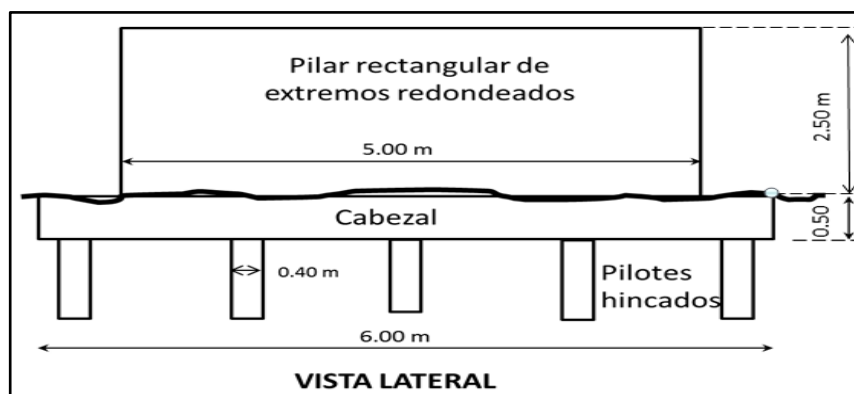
Vista lateral del sistema de pilas del puente Las Flores sobre el río Santa Bárbara. Dibujo sin escala.
